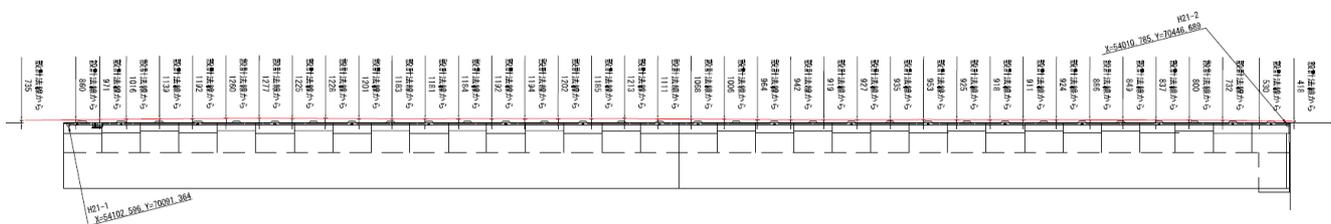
No.1 日立港区_第5ふ頭地区岸壁(-10m)BCの平面図 (被災前後)
